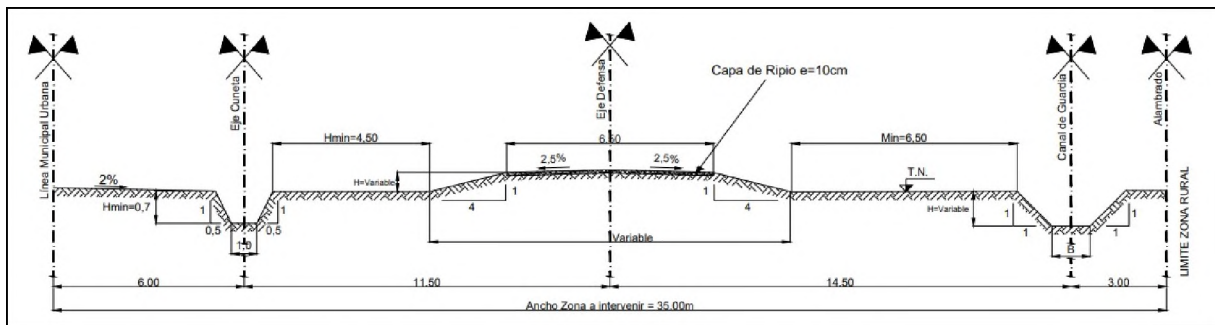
Perfil Transversal Tipo de Defensa y Canal de Guardia
